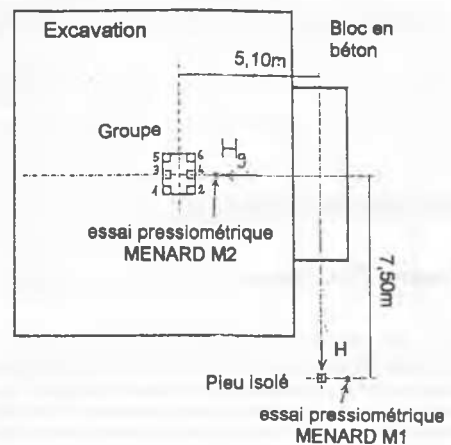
Plan général du site expérimental (d'après Meimon et al., 1986)
